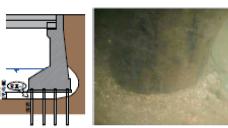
洗掘状況 写真-2 洗掘状況 (松杭露岡)
